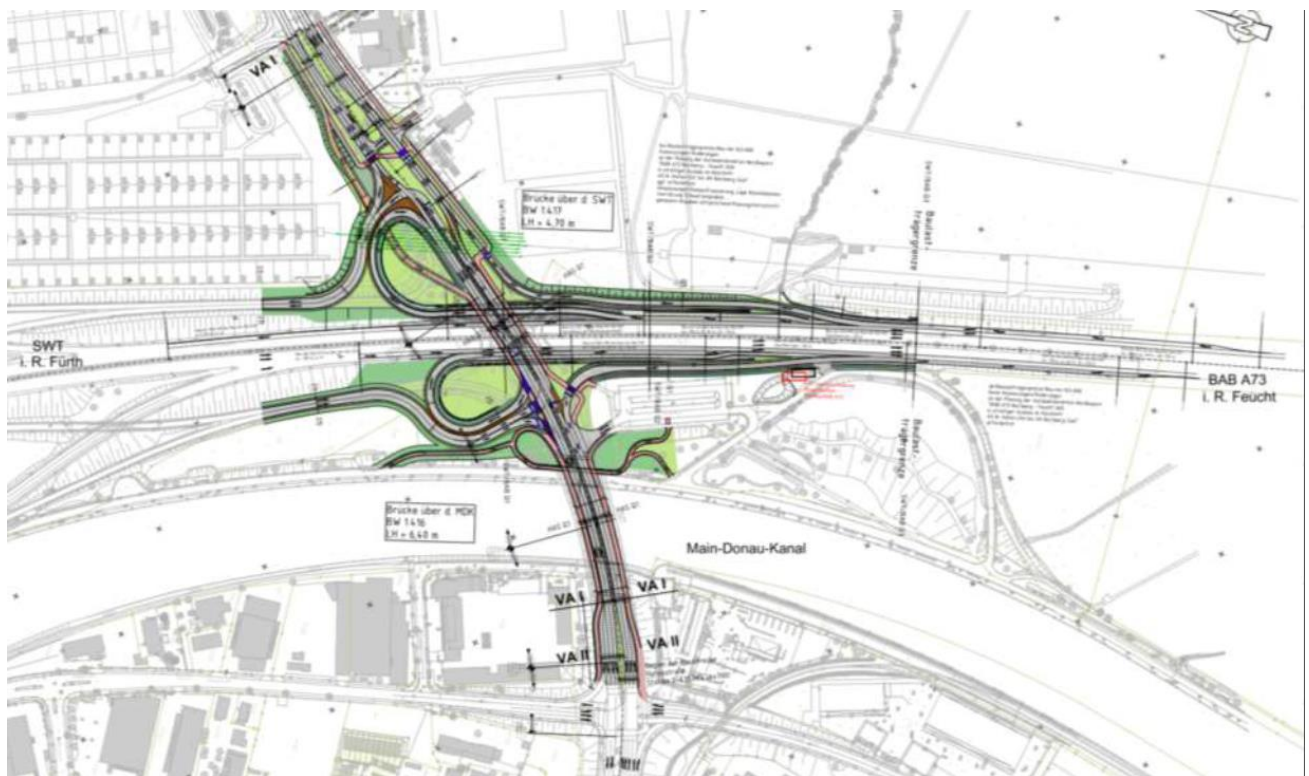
Vorplanung - Variante 7.2 mit LSA - Beschlussvariante
